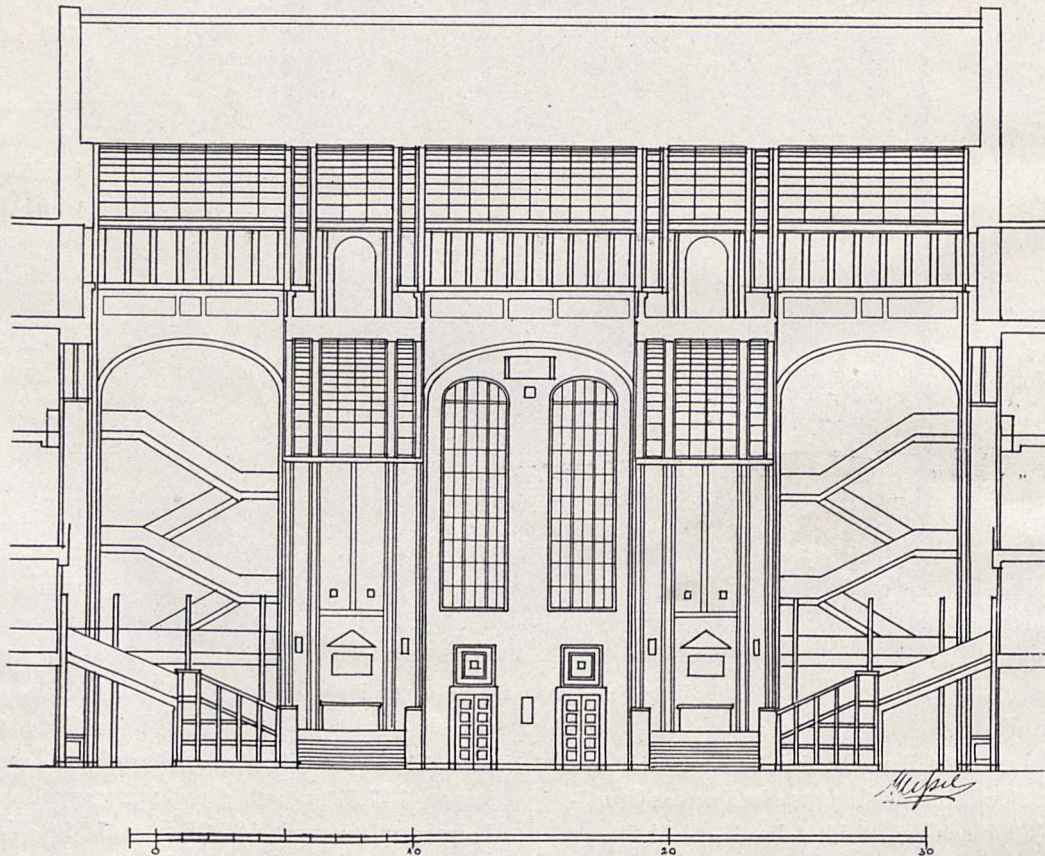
Längenschnitt durch den Lichthof im Bauteil am Leipziger Platz.
